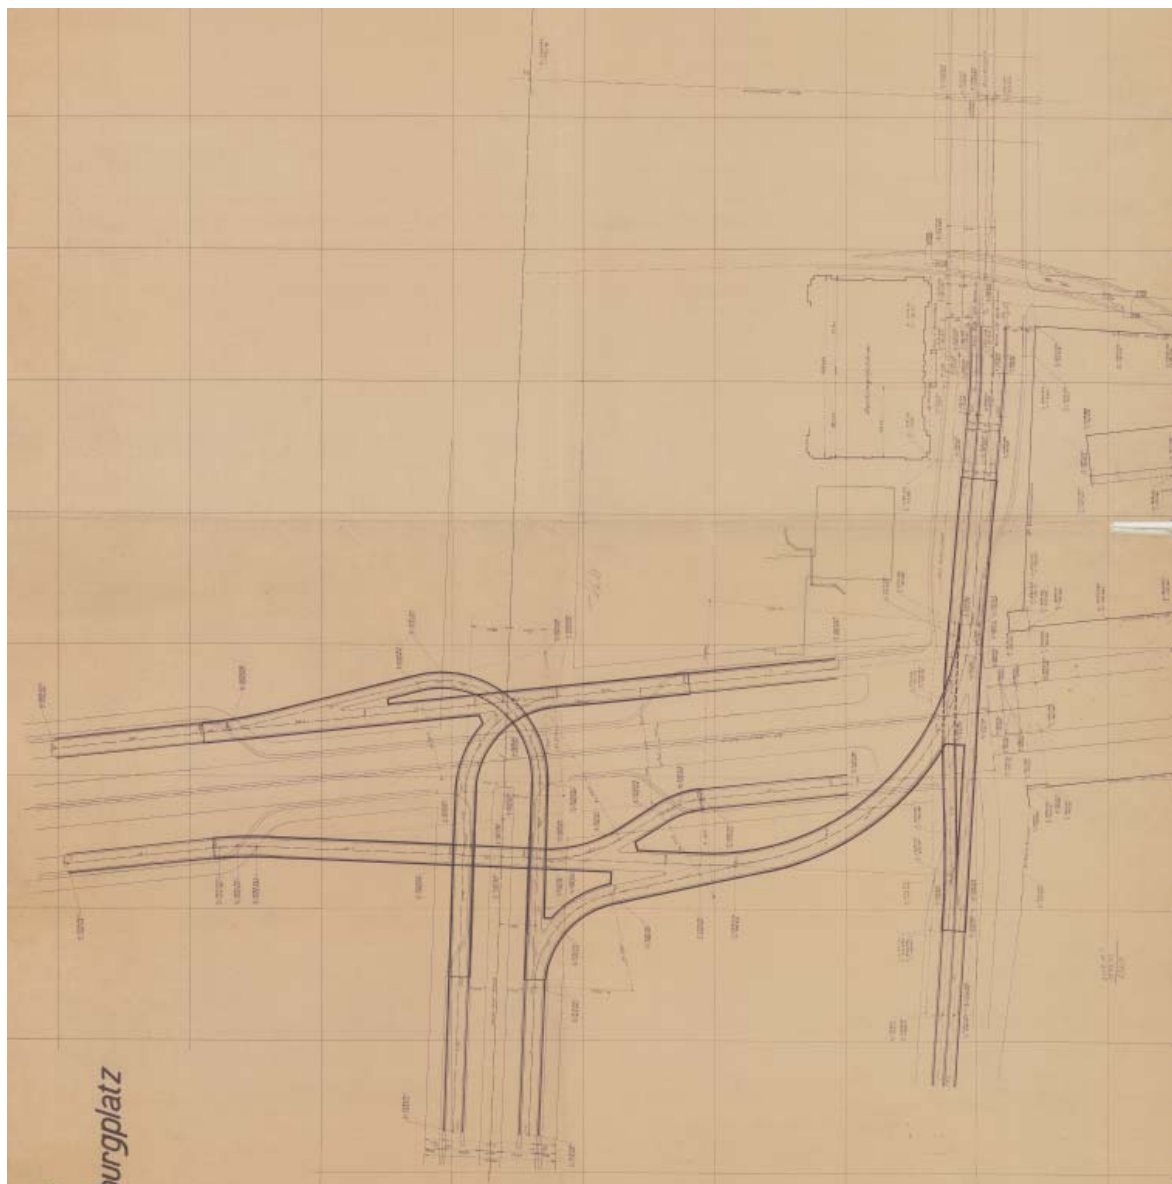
Plan des tunnels de l'«Achsenkreuz», des archives de Berlin.
